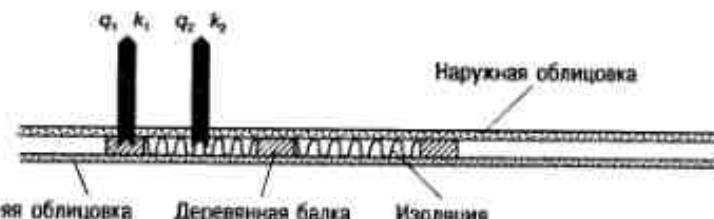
Тепловой поток через неоднородную строительную конструкцию
